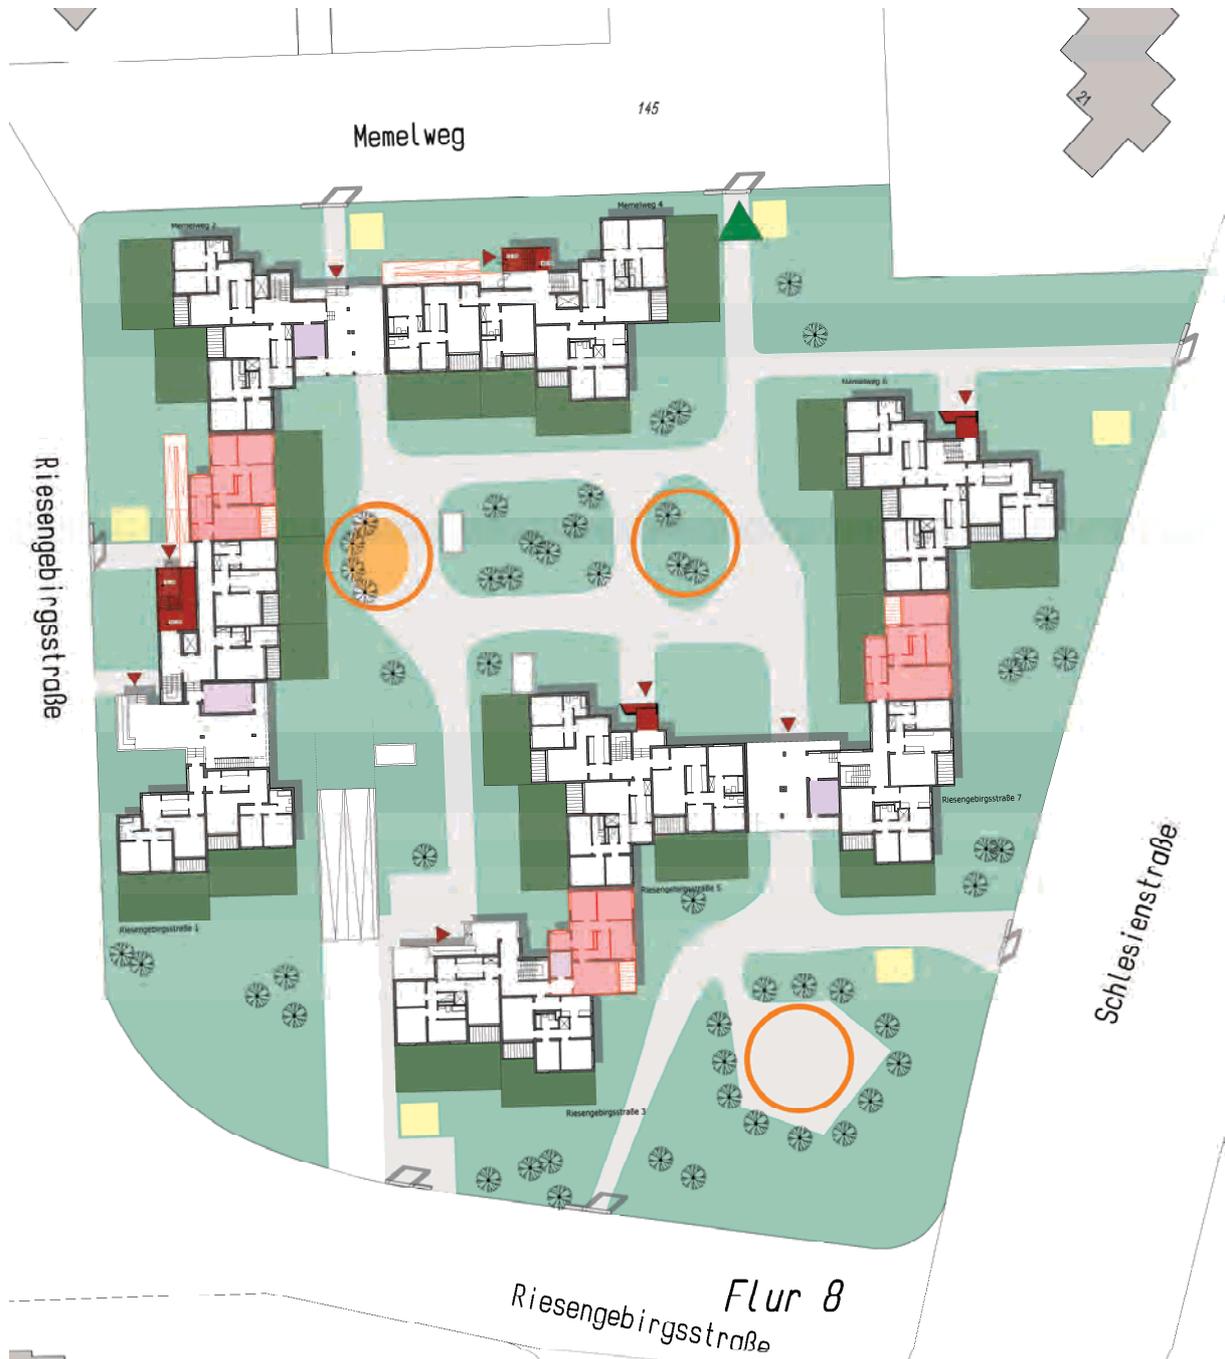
Grundriss Erdgeschoss mit Eingängen und Außenanlagen Block 6
